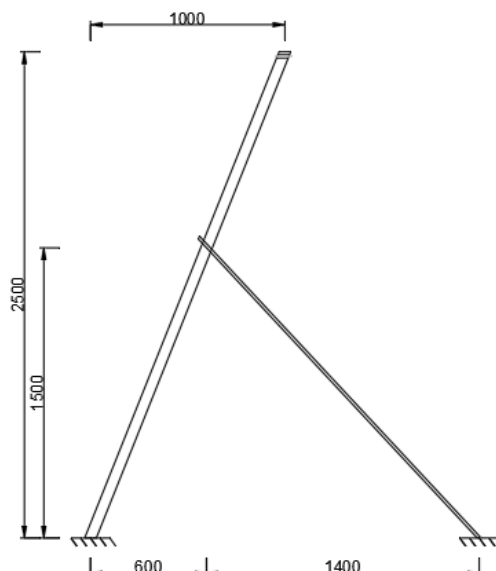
Estructura para tensar el cable en apoyos finales (Fuente: elaboración propia)
